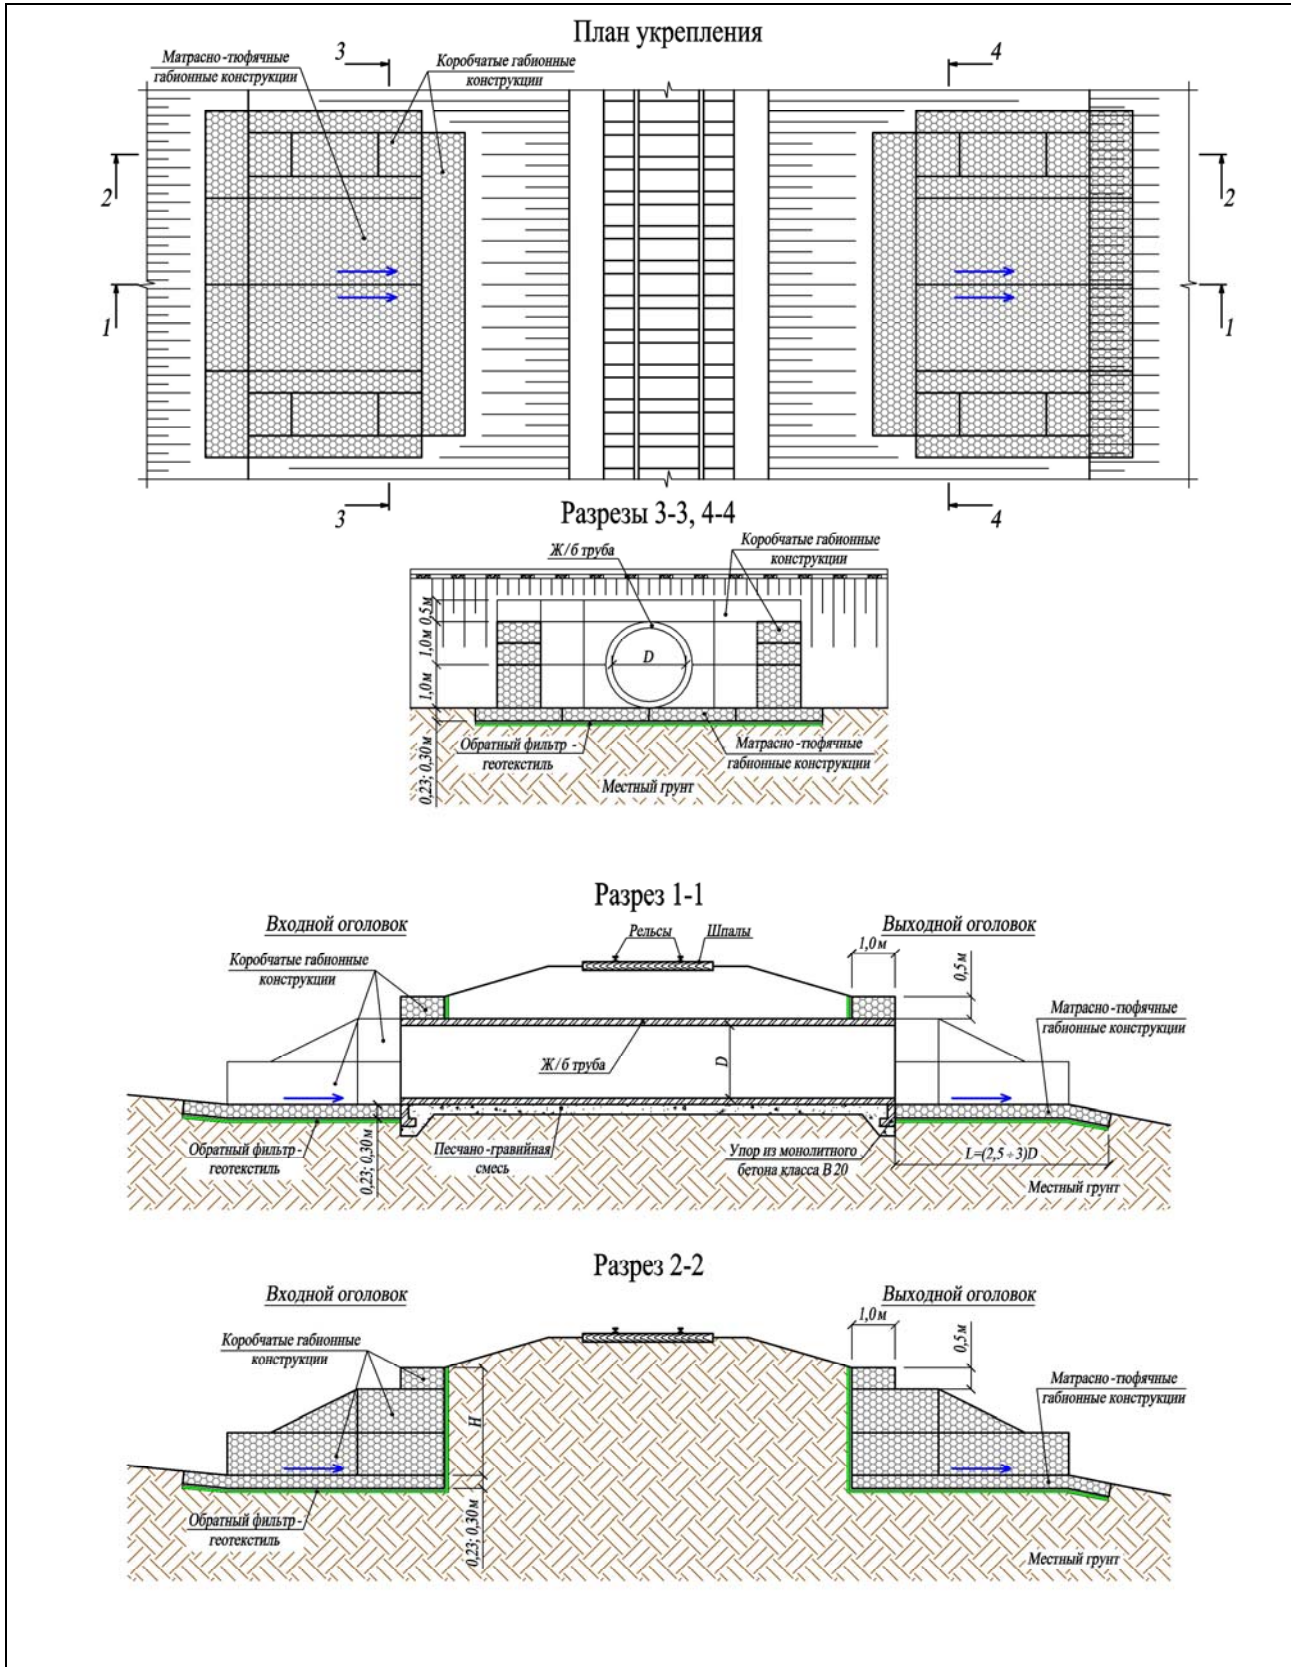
Укрепление оголовков водопропускной трубы открылками из габионных конструкций
